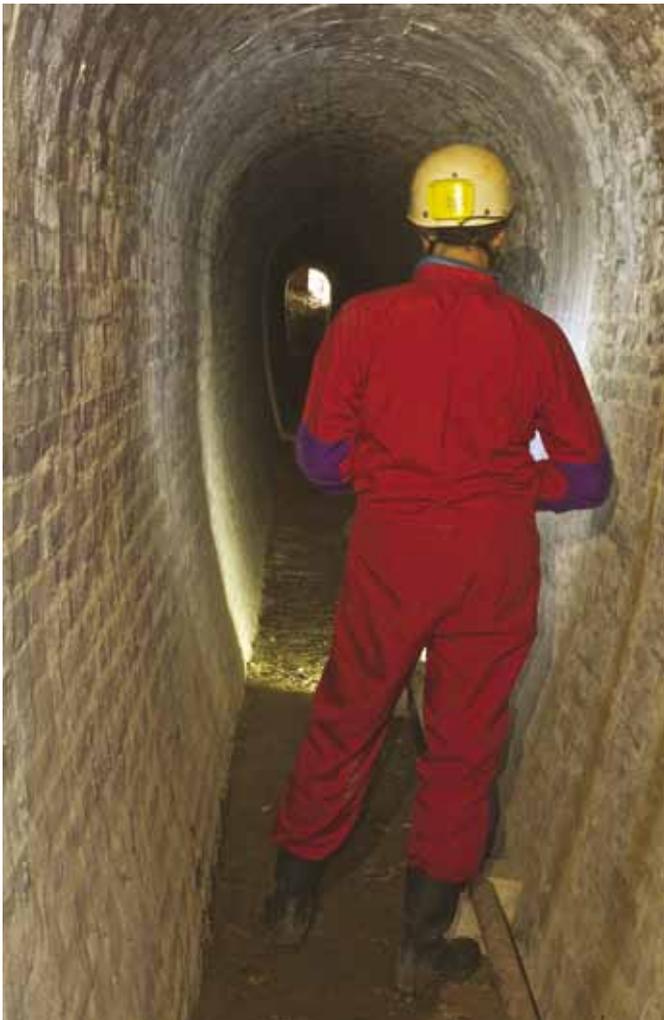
Acquedotto di Dozza, Galleria delle Piombare (1933). Sul pavimento è alloggiata la tubazione (foto R. Simonetti).
